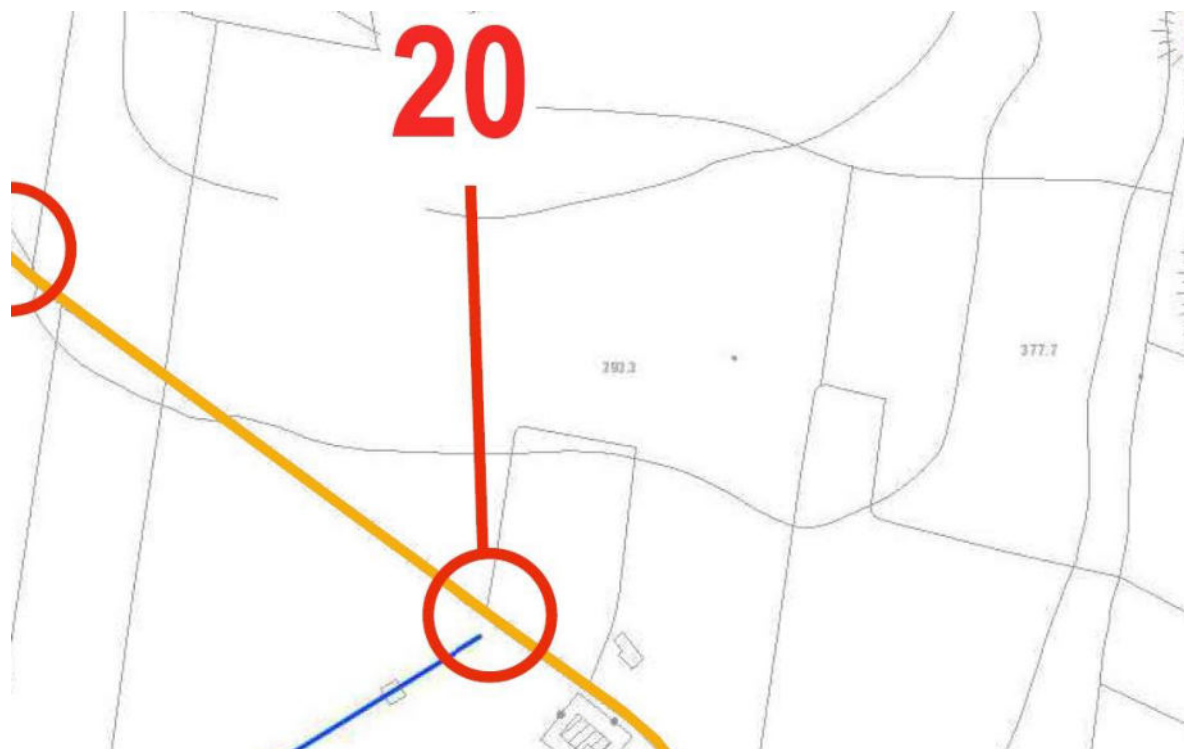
Planimetria CTR con individuazione attraversamento in cls
